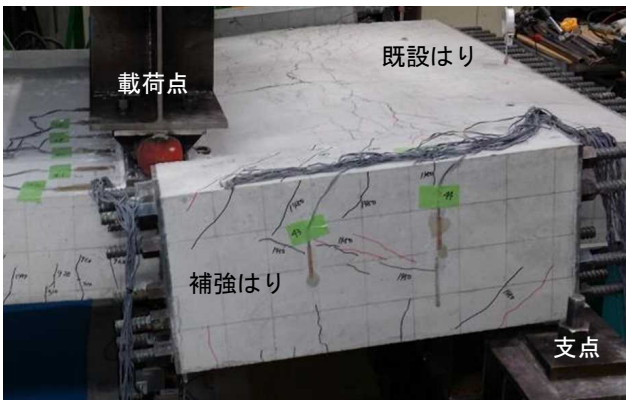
No.2 試験体最大荷重後、荷重低下時 (1168kN) のひび割れ性状
